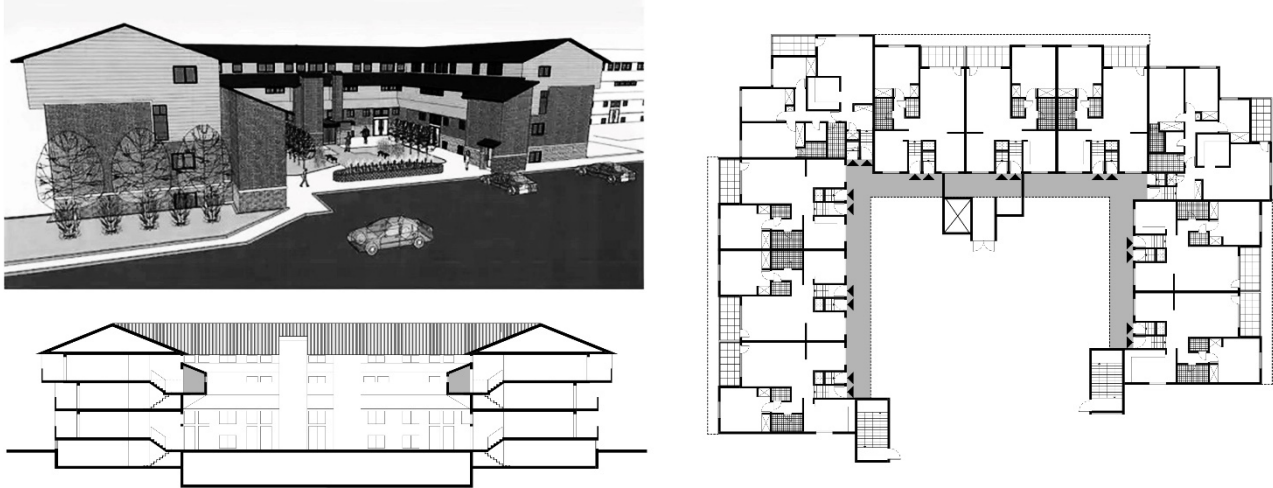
4-поверховий житловий будинок (Navaho Walk Up), Загальний вигляд, план 2-ого рівня (ground floor), розріз. (Фото [15], креслення - Яблонська Г.Д.)
